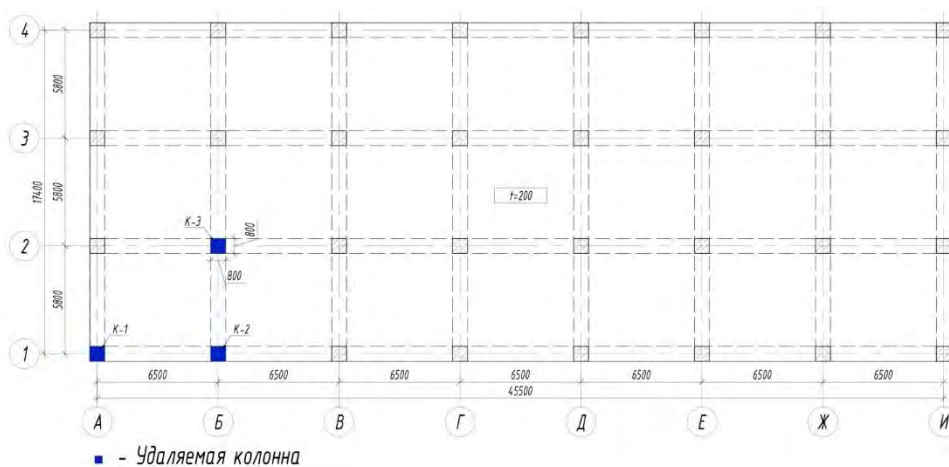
Схема плана первого этажа каркаса здания с указанием удаляемых колонн
